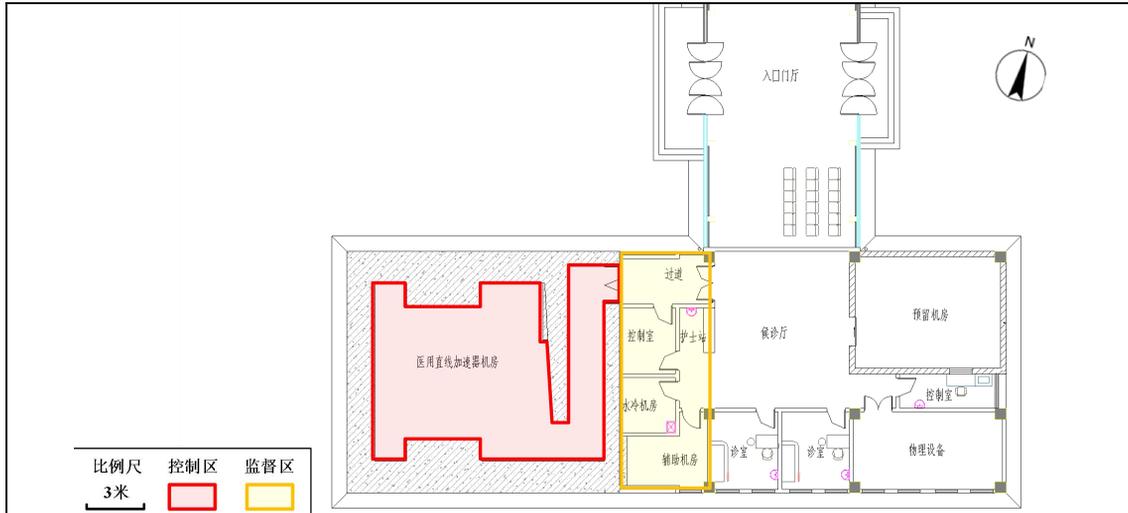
本项目医用直线加速器机房平面布置及分区示意图
